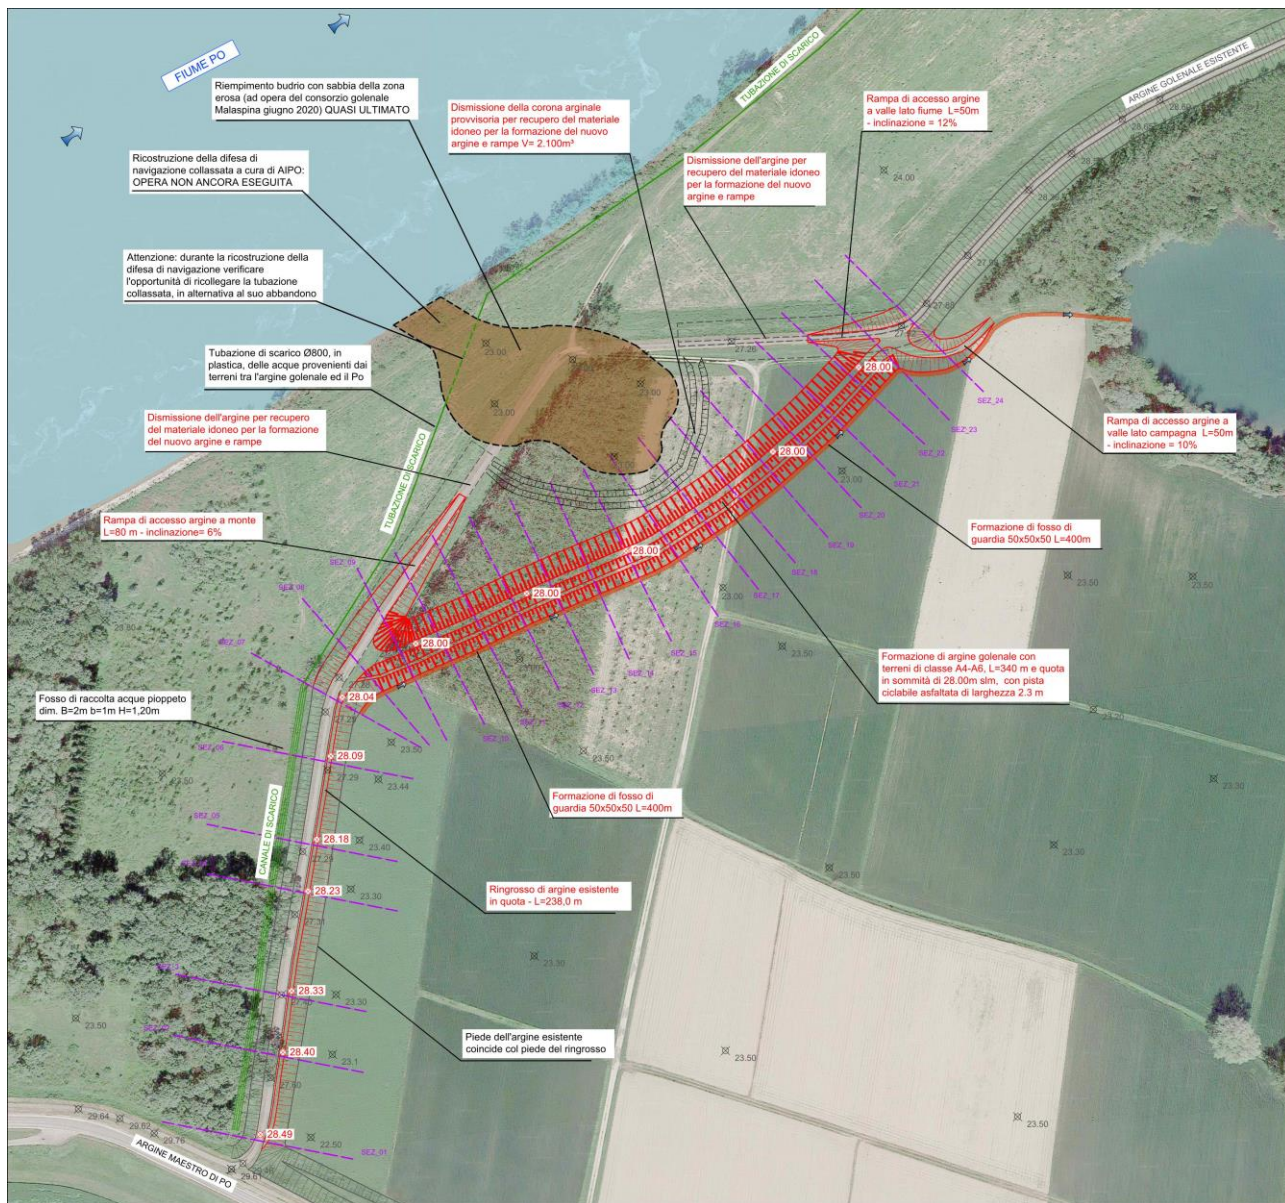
PLANIMETRIA DI PROGETTO
